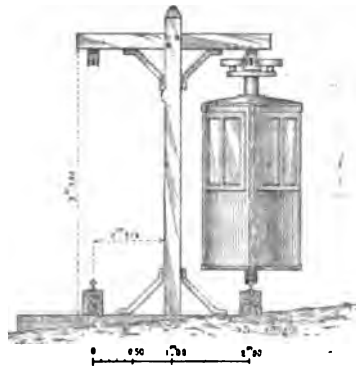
Chemin de fer bicycle Boynton. — Coupe transversale de la voie et vue en bout de la voiture.
